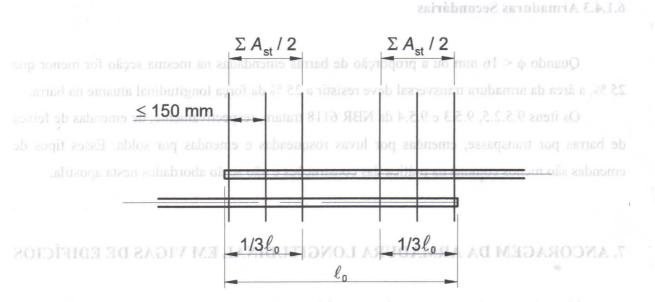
Disposição da armadura transversal nas emendas de barras tracionadas.
